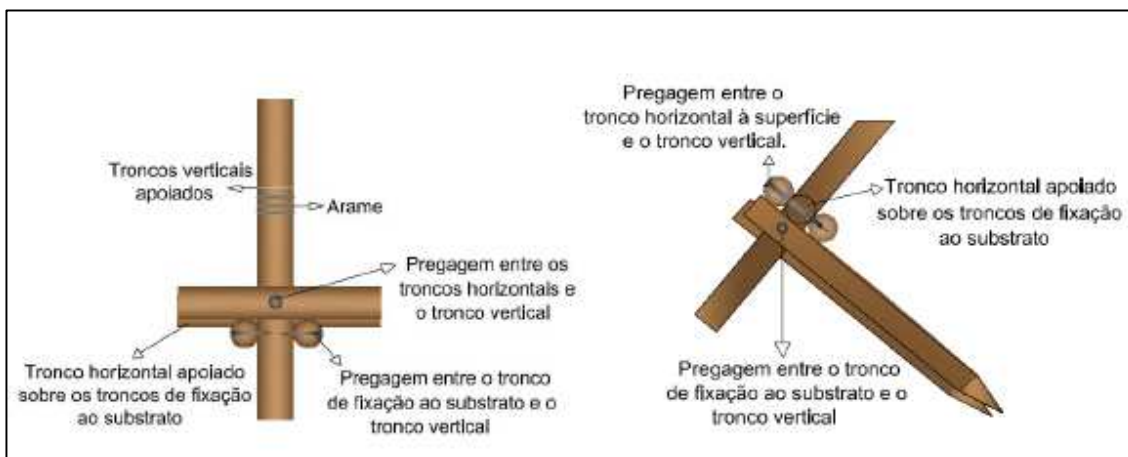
Esquema do pormenor dos encaixes de uma construção do tipo grade viva, (Martinho, P., 2005).
